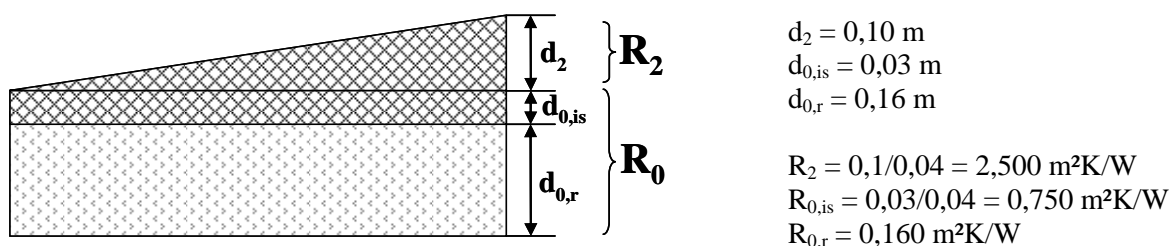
Subdivision d'un élément de construction en parties planes et parties en pente
